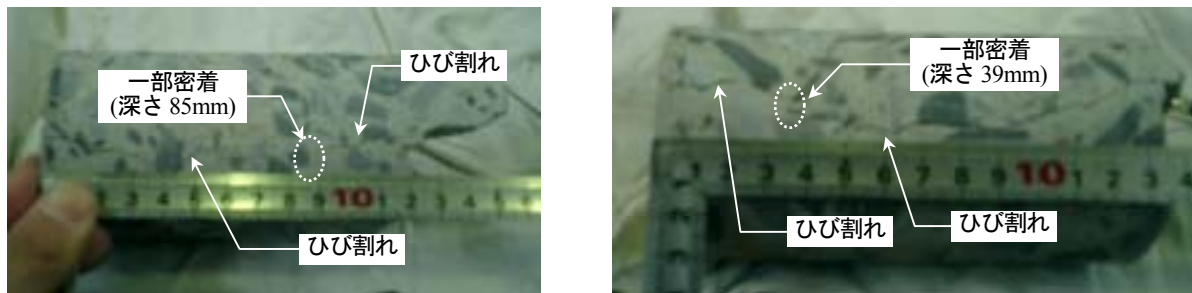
ひび割れ位置で採取したコアの状況 (左図：南面①, 右図：東面)
